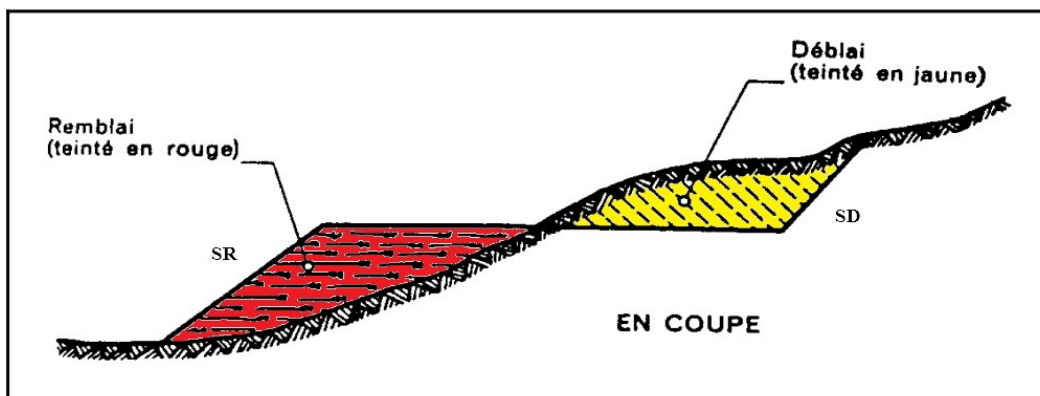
Profil en travers d'une route montre les surfaces de déblai et remblai
